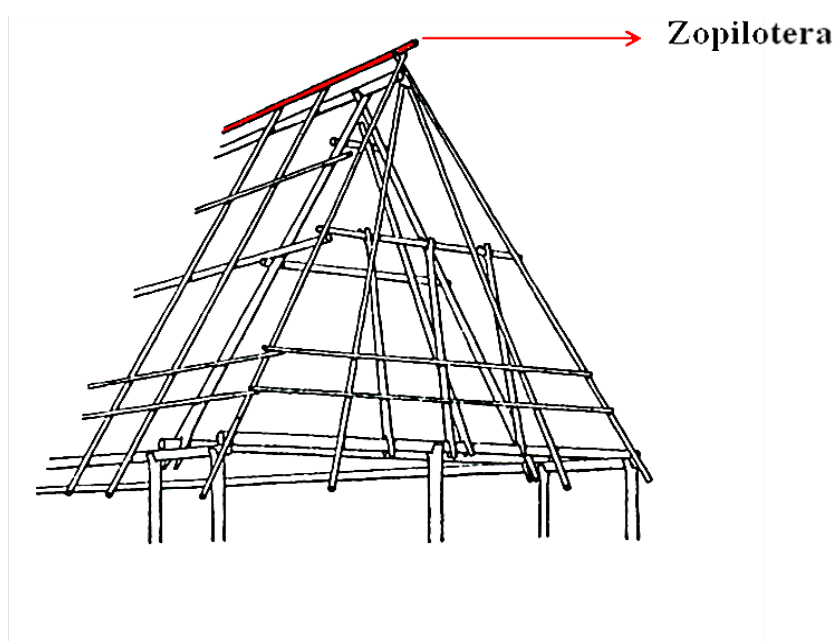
Vista de la Zopilotería en la estructura del techo. Tomado de Wauchope 1938: figura 16.
